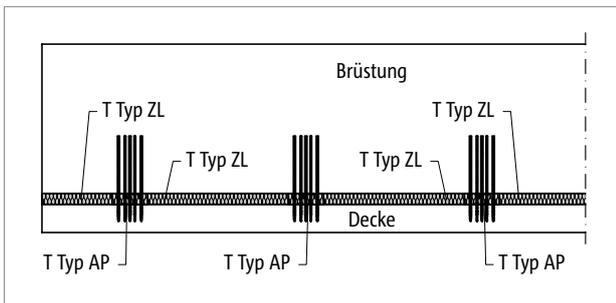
Schöck Isokorb® T Typ AP vertikale Anordnung: Ansicht Brüstung aufgesetzt
